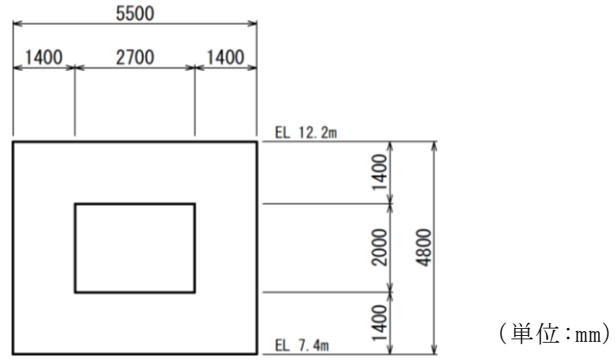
第 1 ベントフィルタ格納槽 断面図 (D-D 断面)
